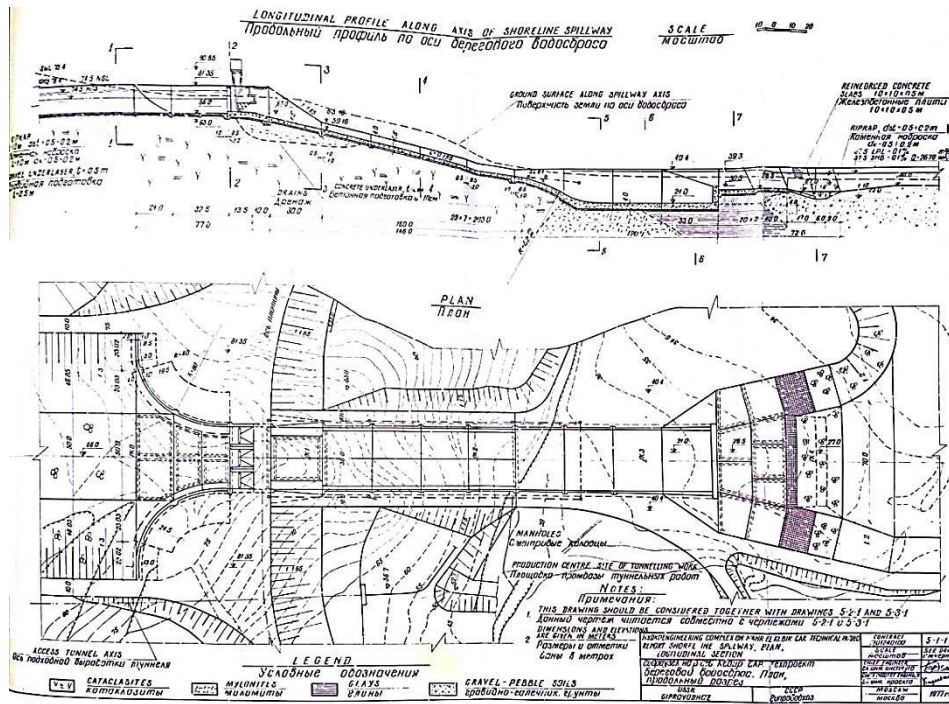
План и продольный разрез по оси берегового водосброса
